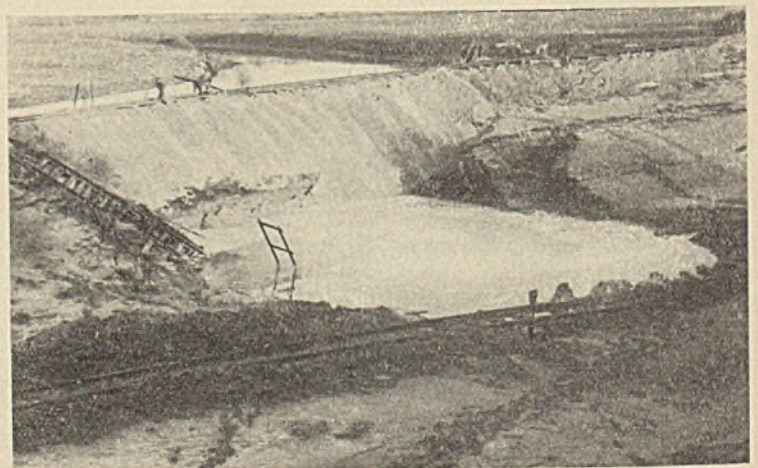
Der untere Abschlußdamm des Schleusenkanals nach seiner Wiederherstellung.
